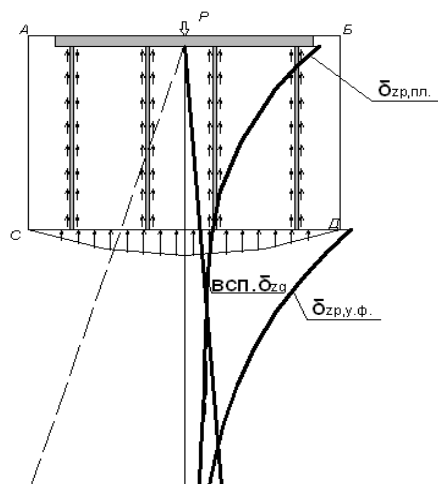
Расчетная схема к определению осадок плитно-свайного фундамента
